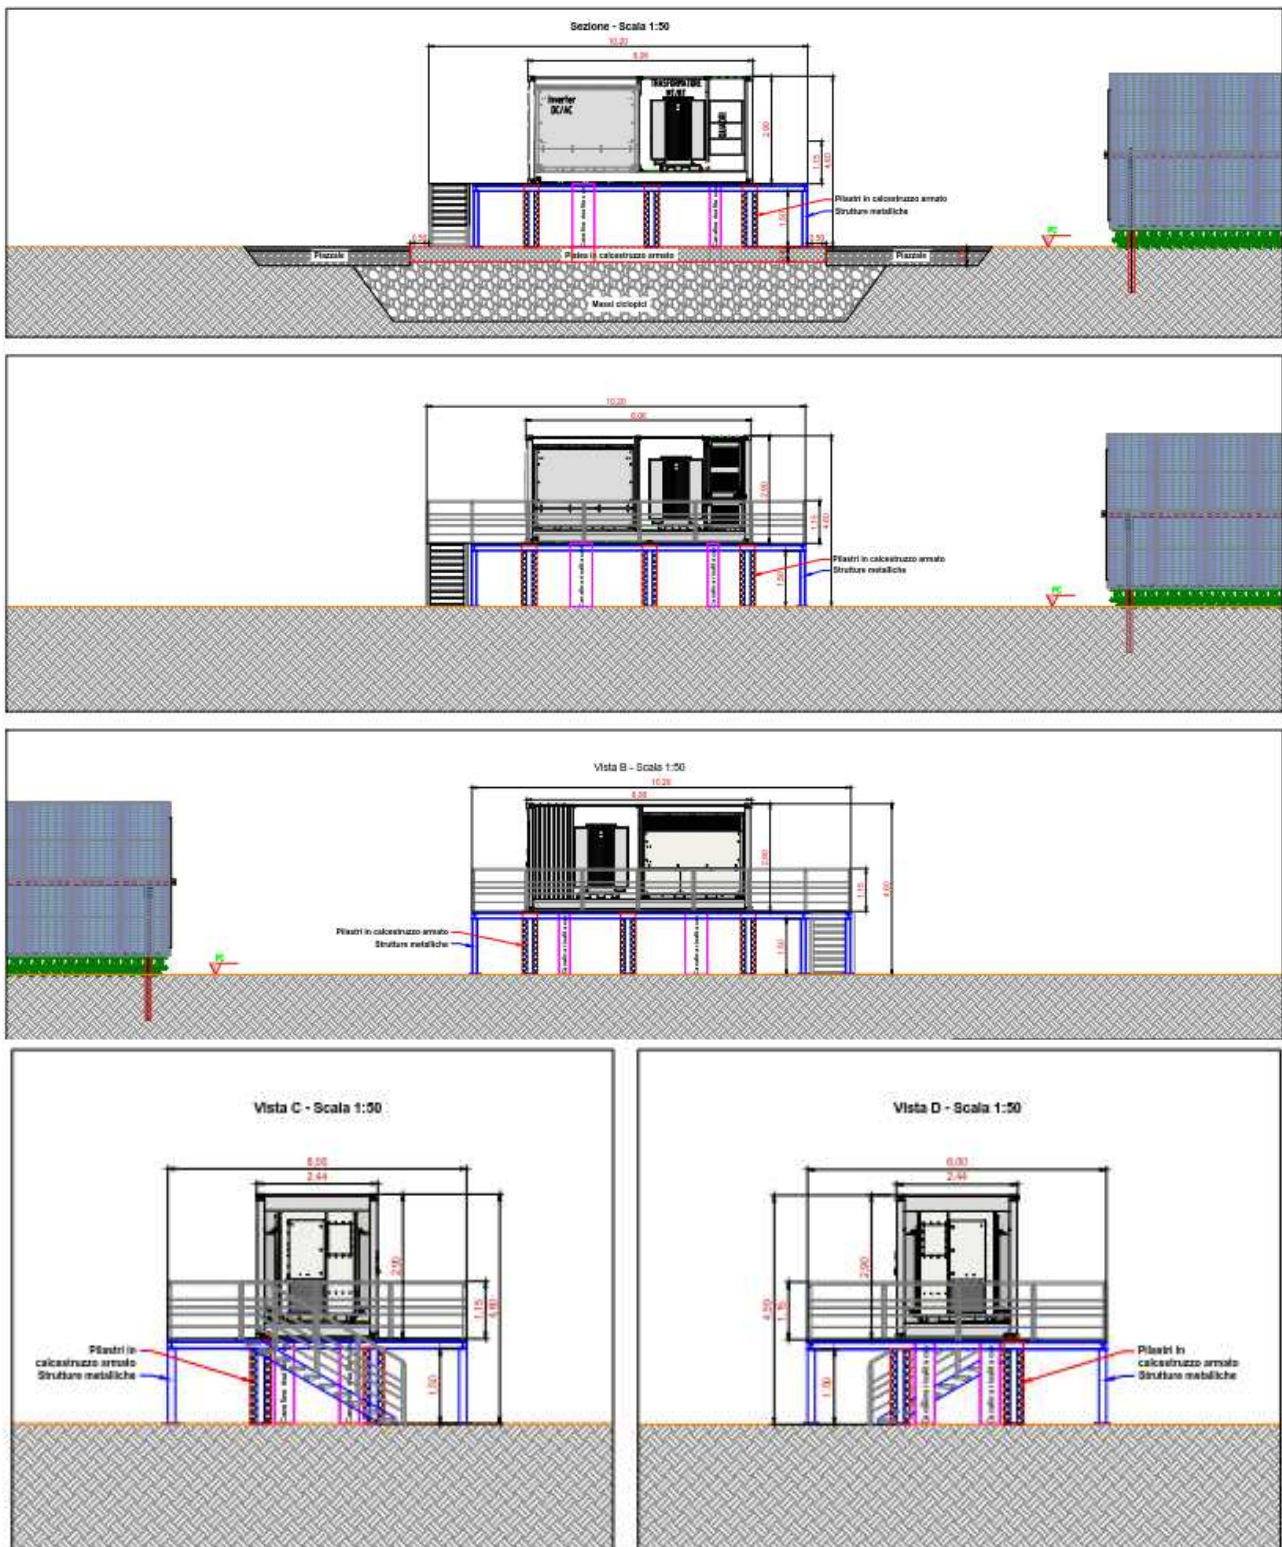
Estratto tavola 15b "Tipico power station sopraelevata (cabina inverter e trasformatore)".
